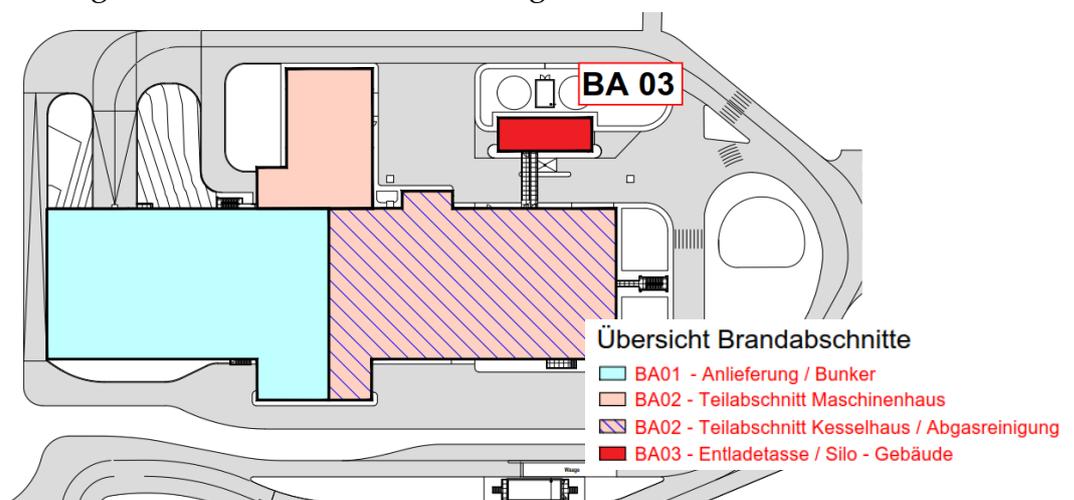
Lage Brandabschnitt BA 03 – Silogebäude/Pumpenstation
